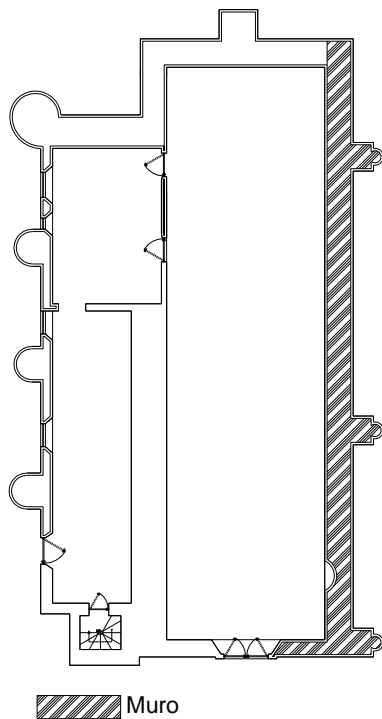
Muro de mampostería aparejada de la capilla de la San Miguel Arcángel Fotografía y dibujo Autor JOBG, Año. 2017
